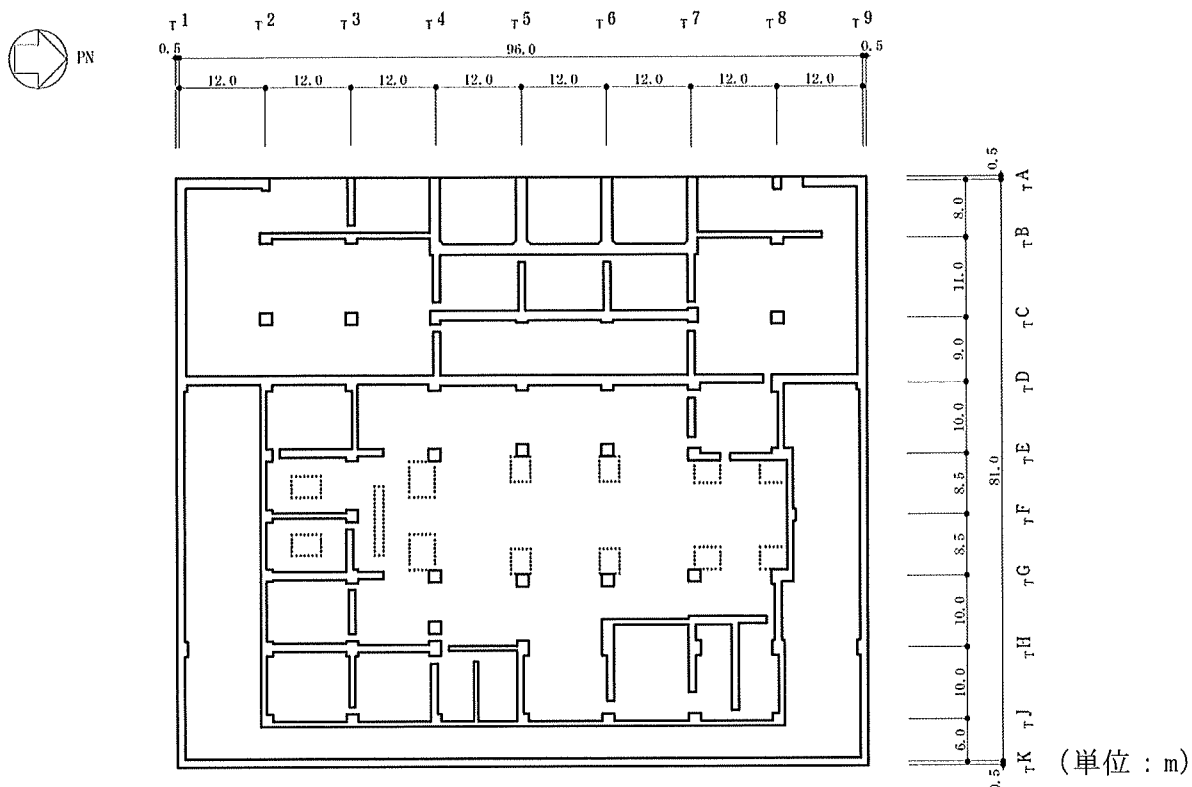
タービン建屋の概略平面図 (B2F, T.M.S.L. -5.1m) (1/6)
